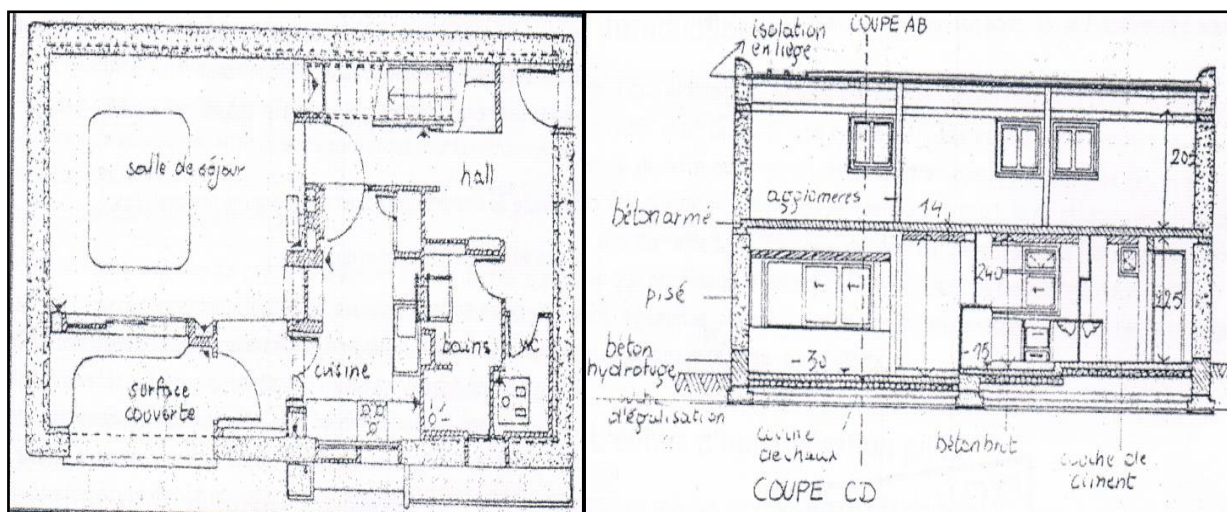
Plan et coupe d'une maison du village de Mostapha Ben Brahim.
